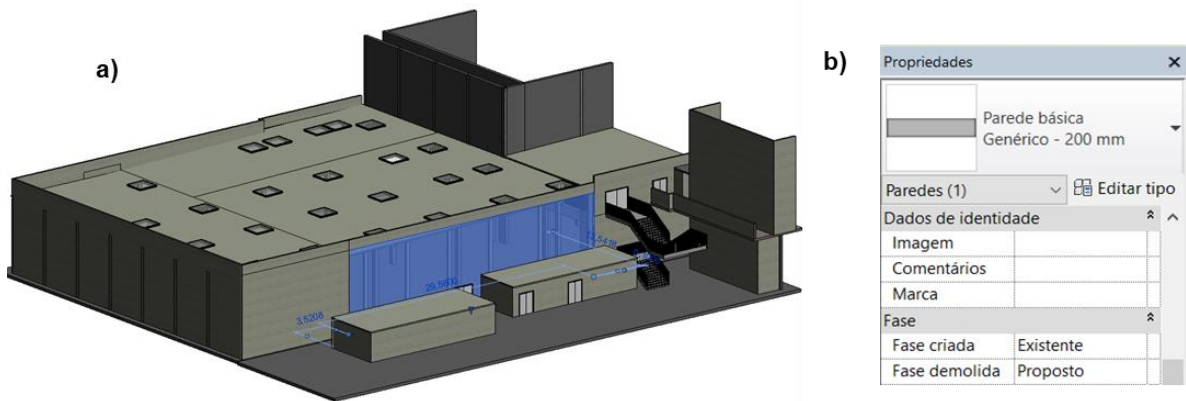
Modelo BIM em Revit; a) Seleção de parede a demolir no modelo; b) Propriedades: Definição da fase de demolição;
